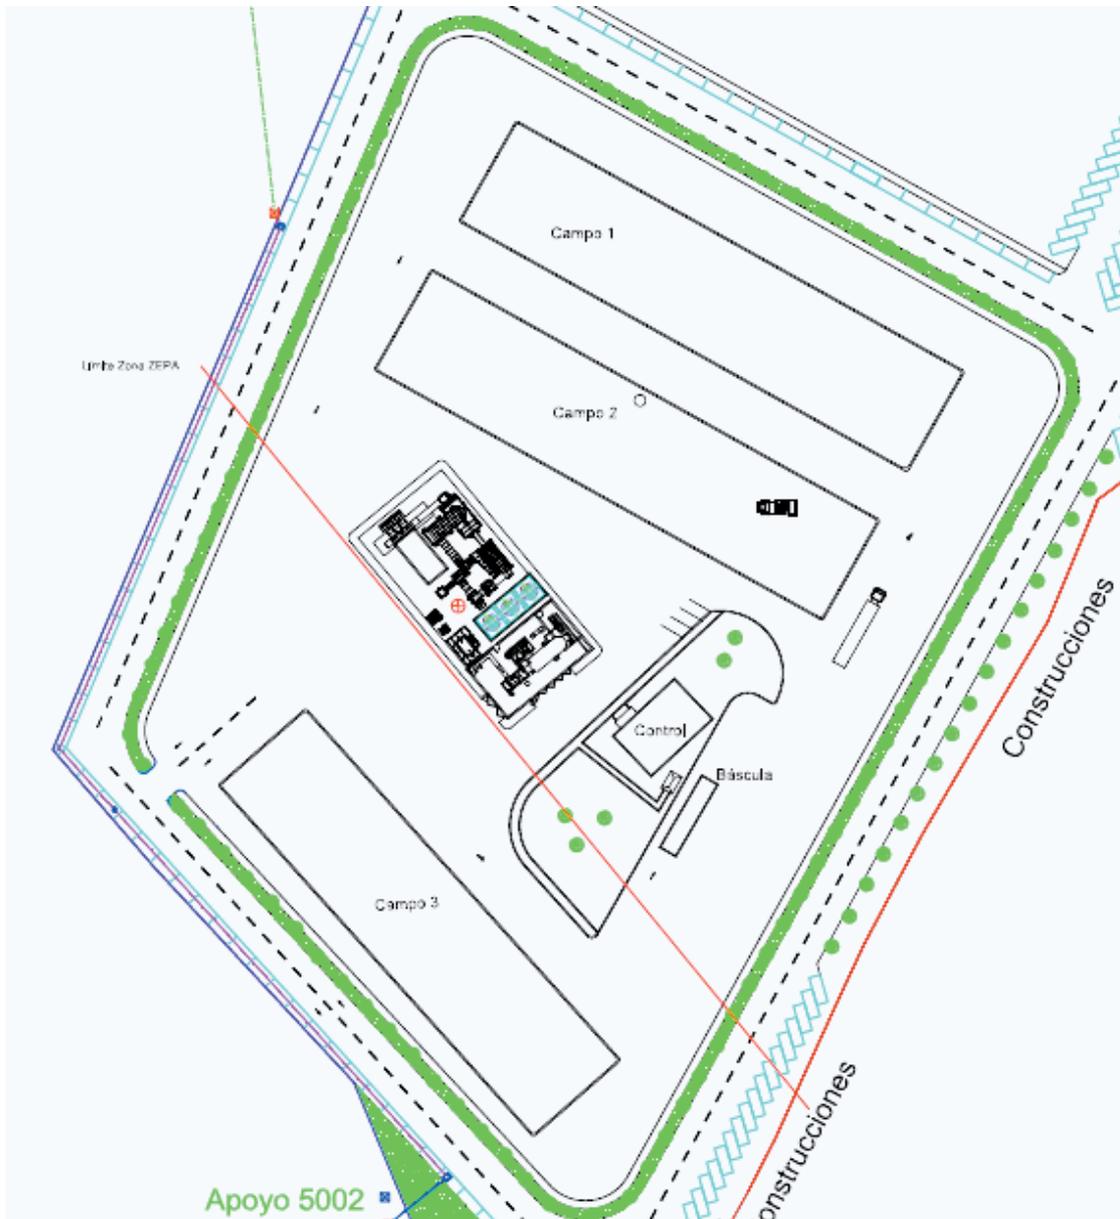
Plano en planta de instalaciones, infraestructuras y equipos.
